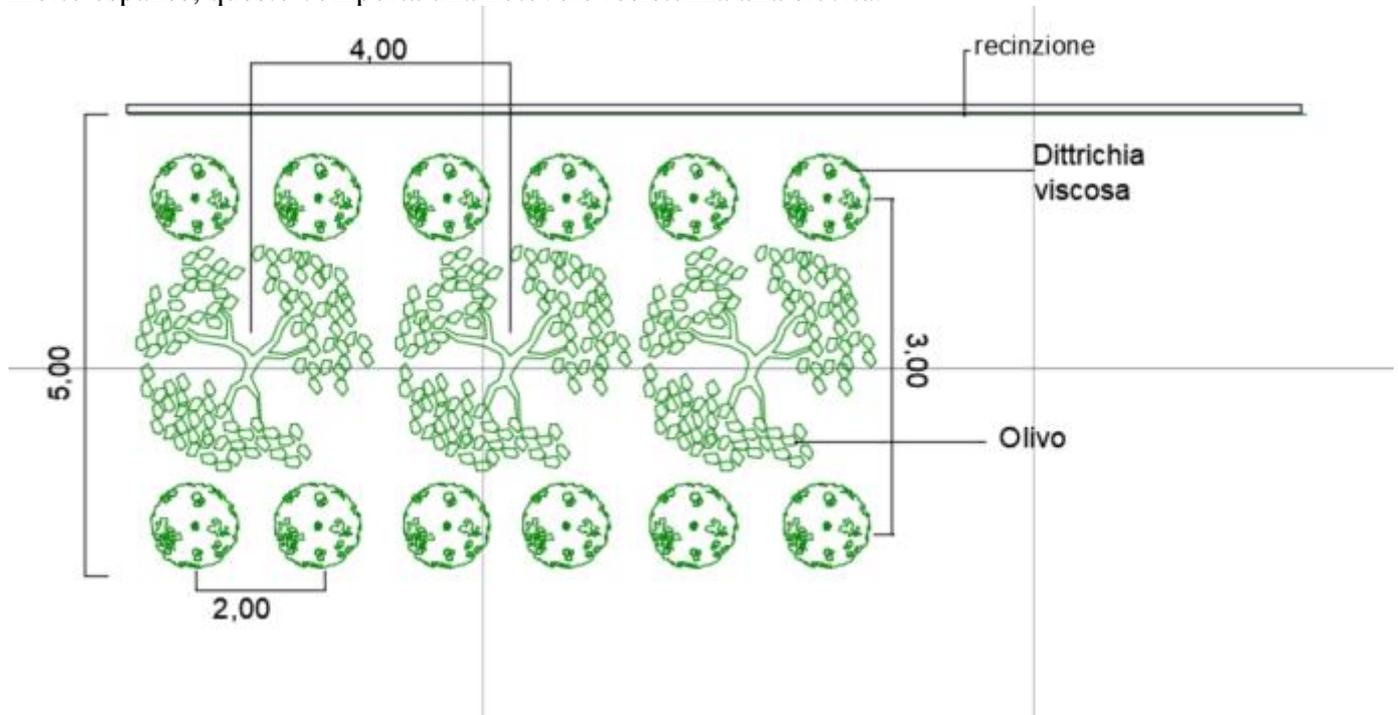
Planimetria esplicativa della distribuzione delle piante all'interno della fascia perimetrale
